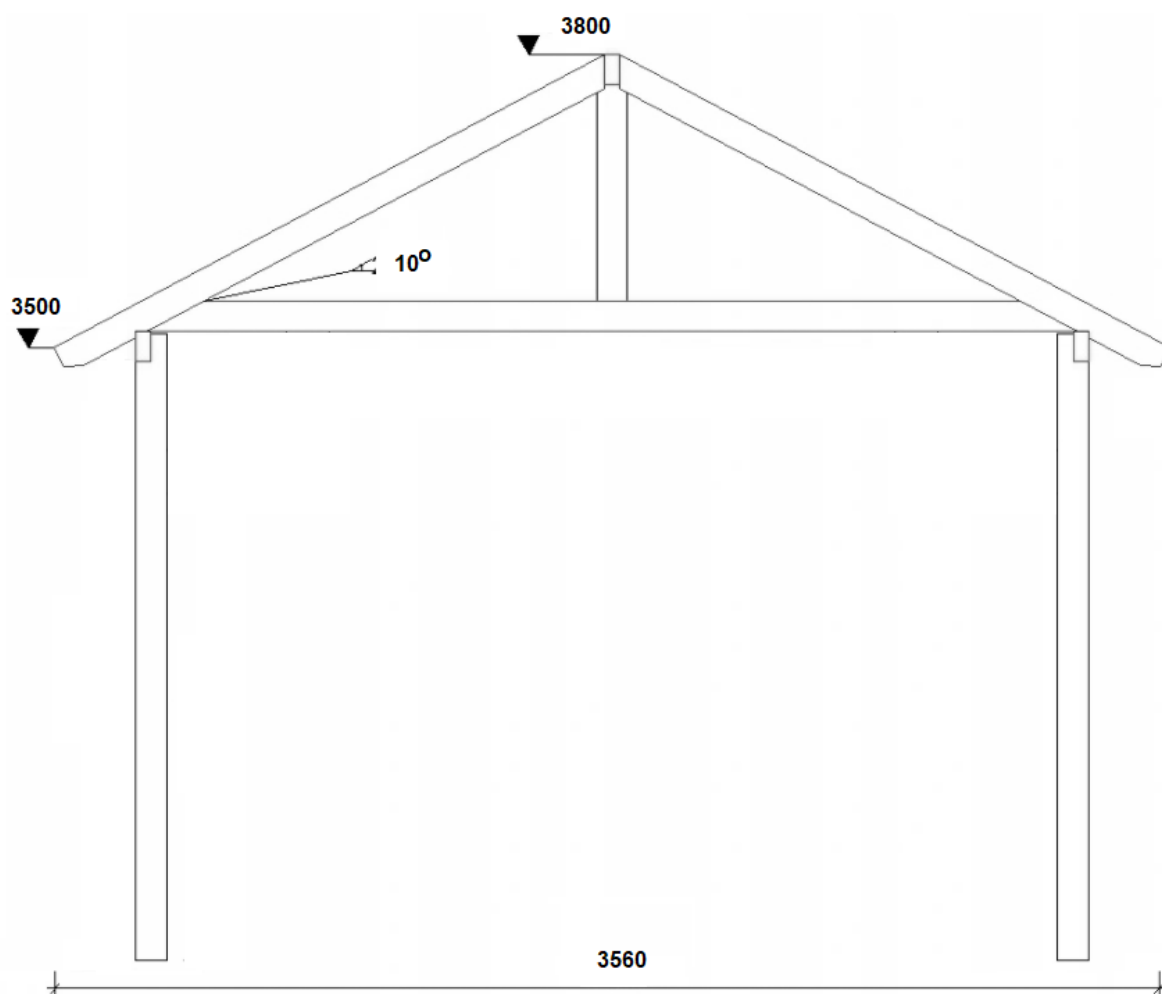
Przykładowa konstrukcja wiaty stalowej
